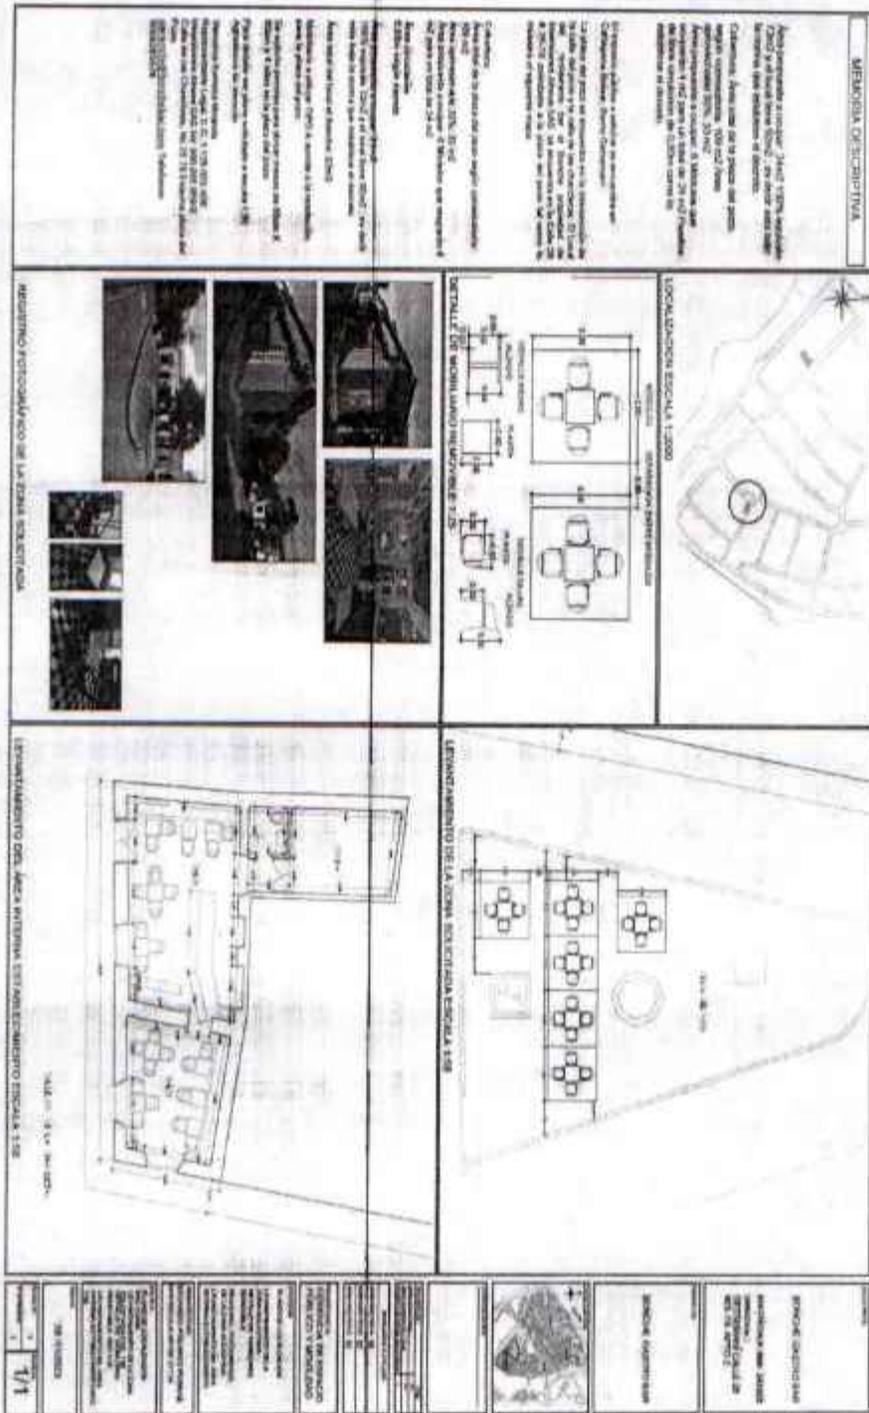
Plano RESTAURANTE BONCHE GASTRO BAR.
